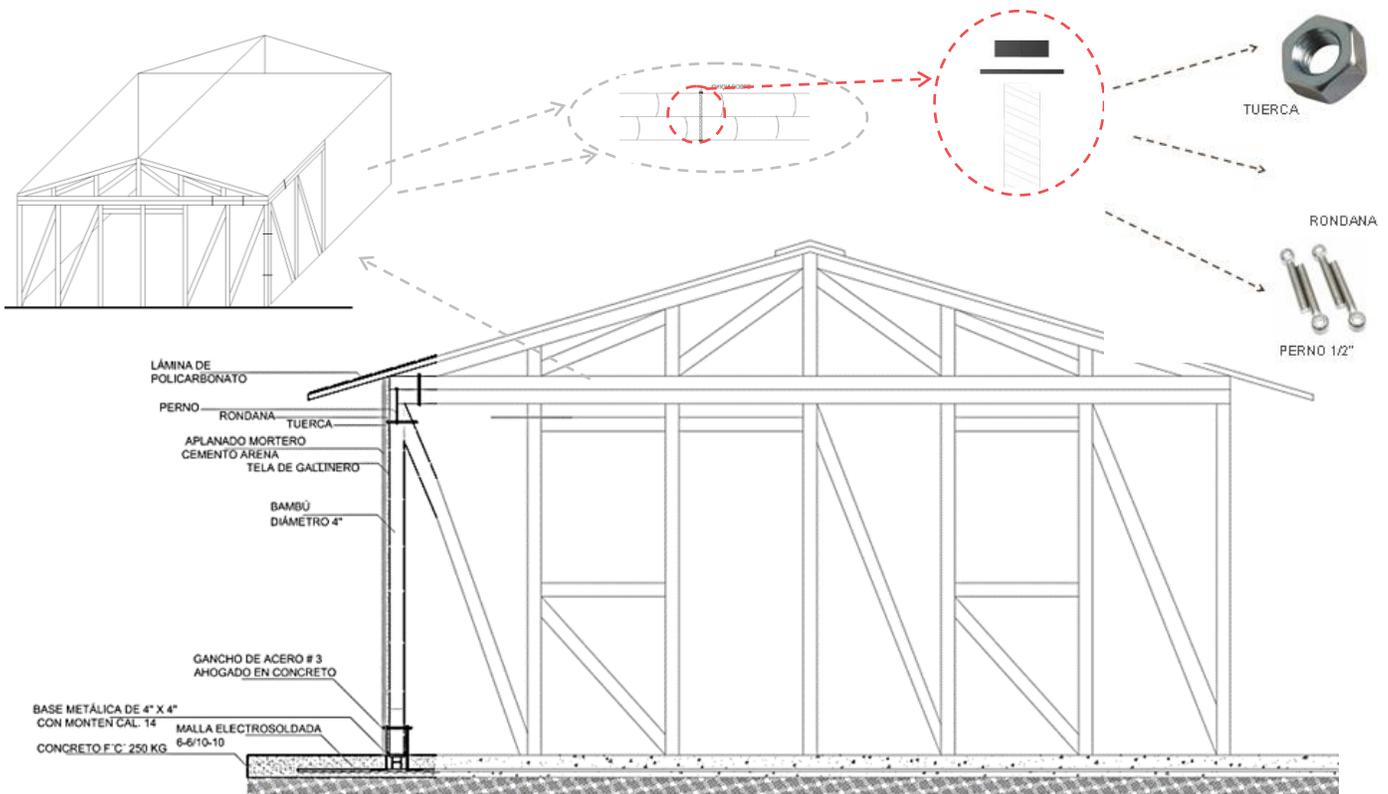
Estructuras Pratt en techumbre de vivienda
